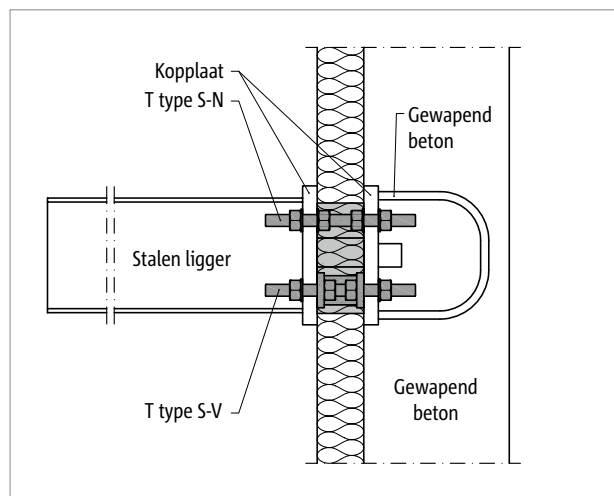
Schöck Isokorb® T type S: Buitenhoeek
